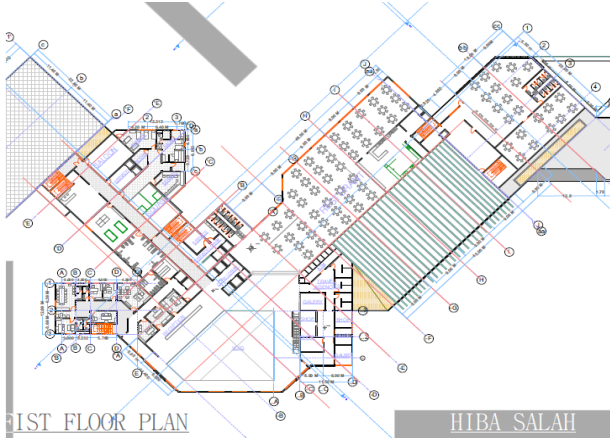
الفكرة المبدئية ROOM FLOORS
